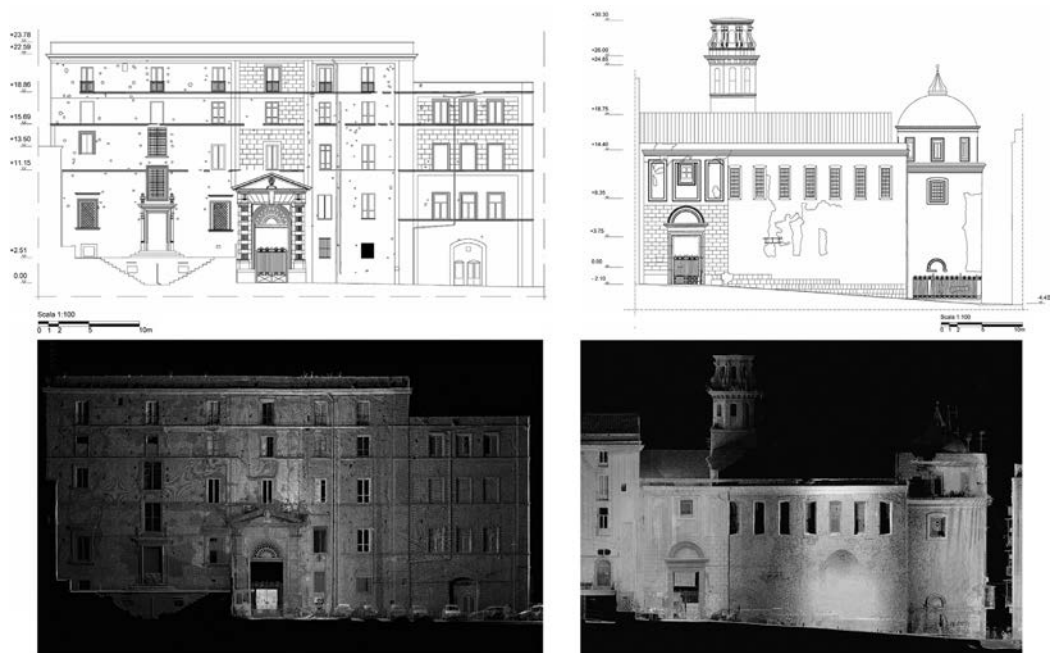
A destra il prospetto dell'ingresso principale su via Maria Longo; a sinistra il prospetto nord su via Capozzi.
